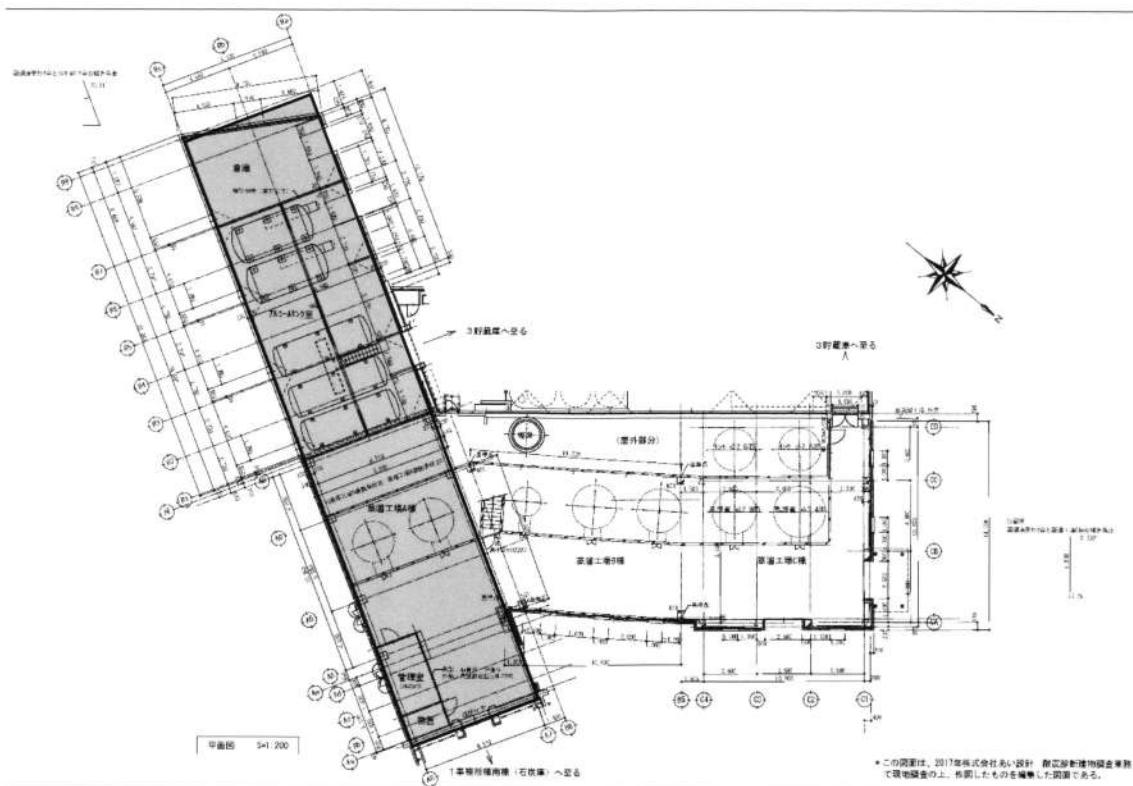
蒸溜工場 B 棟 C 棟平面図
